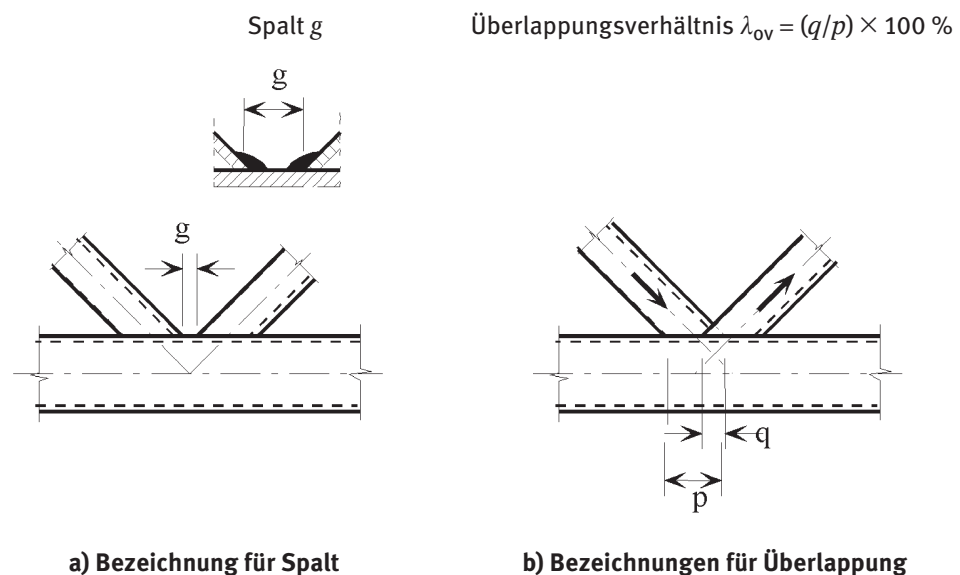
Knotenanschlüsse mit Spalt und mit Überlappung
